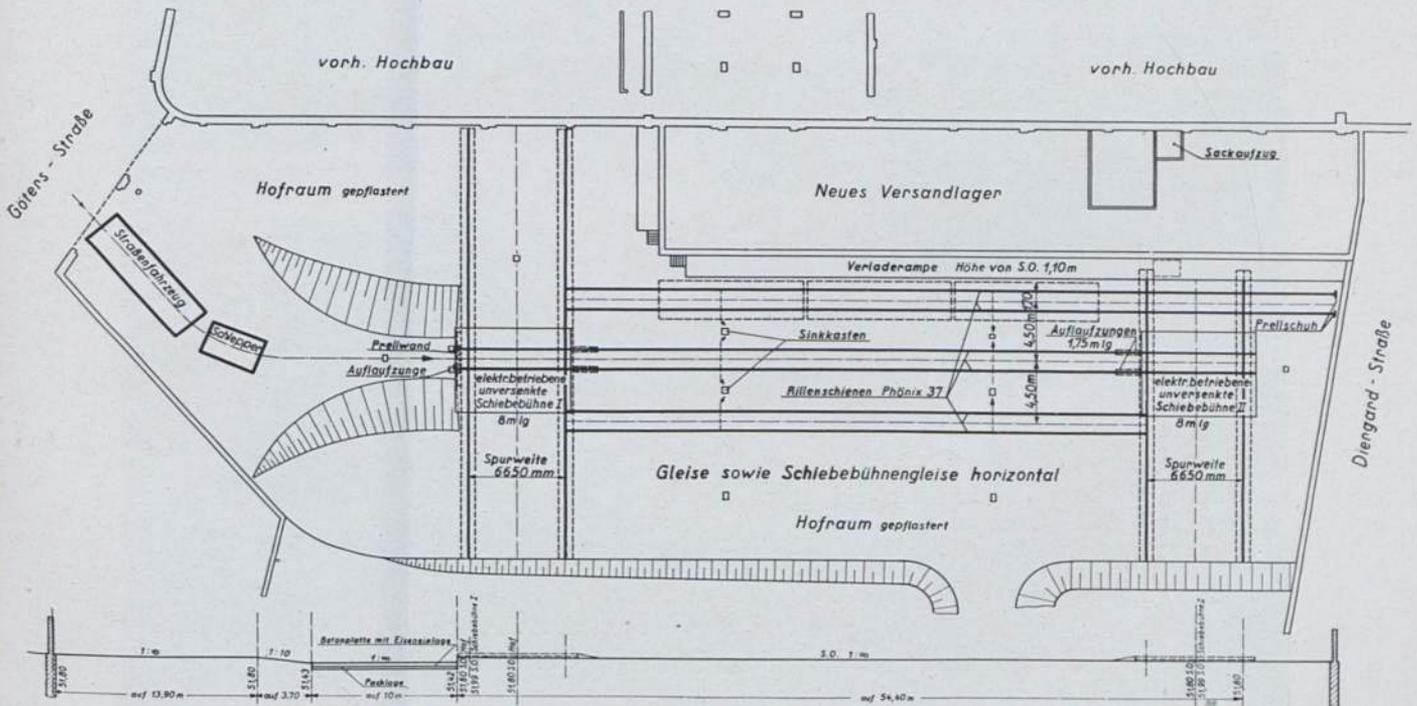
Normalspurige Absetzgleisanlage mit Schiebebühnen für Firma Kaiser's Kaffeegeschäft, Viersen, Abt. Schokoladenfabrik (Lageplan).
